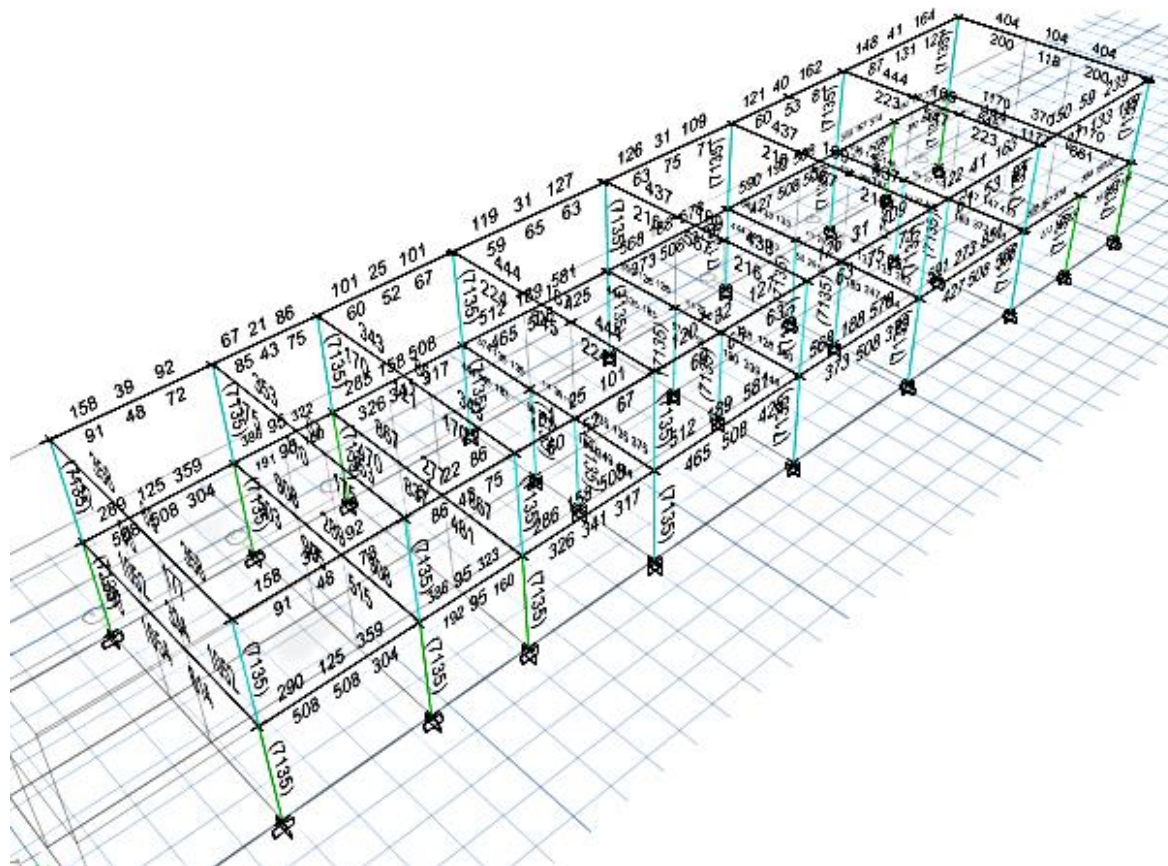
Refuerzo longitudinal de la zona B, ETABS 2015. Fuente: Autor.
